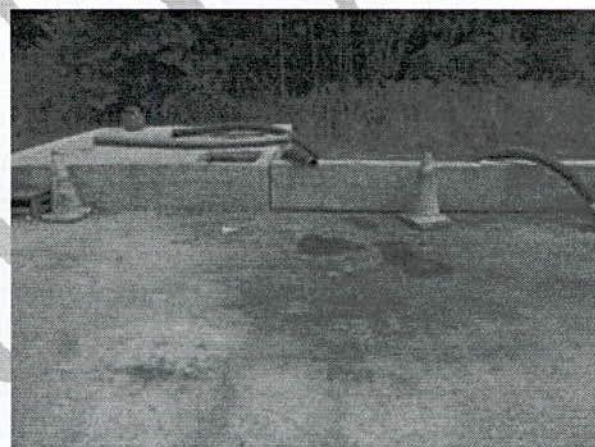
ETE Ipanema – Caixa de Chegada/Reunião do Esgoto Coletado
